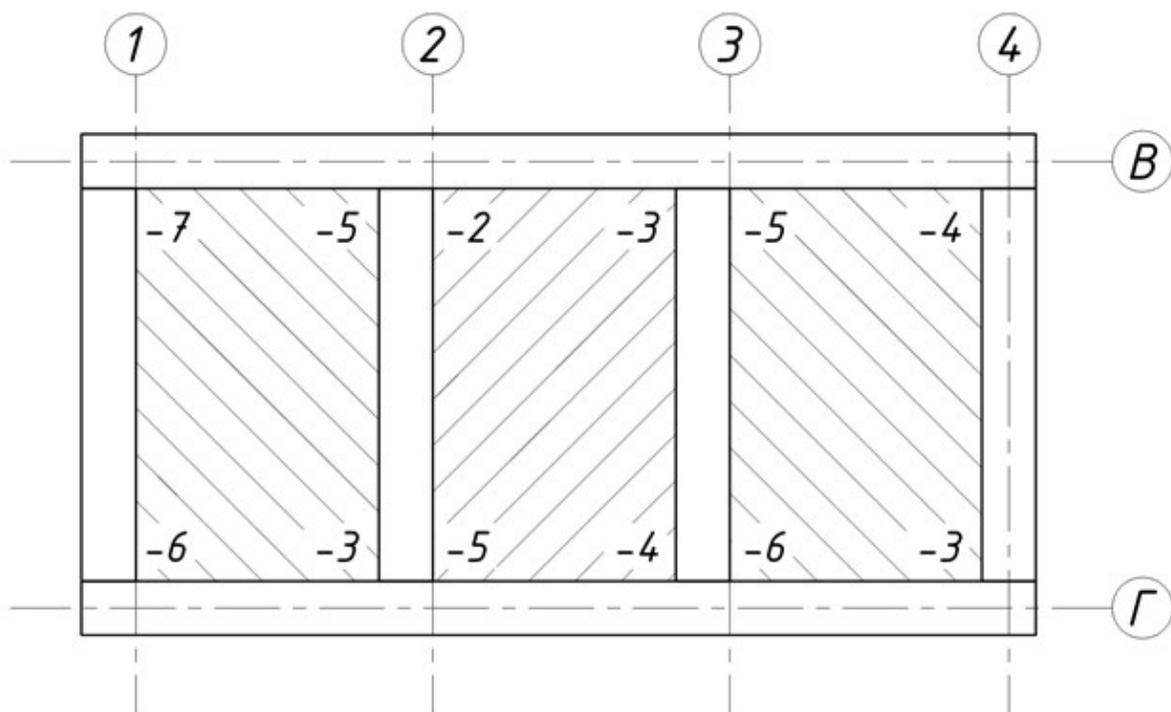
Пример исполнительной схемы плит перекрытия
